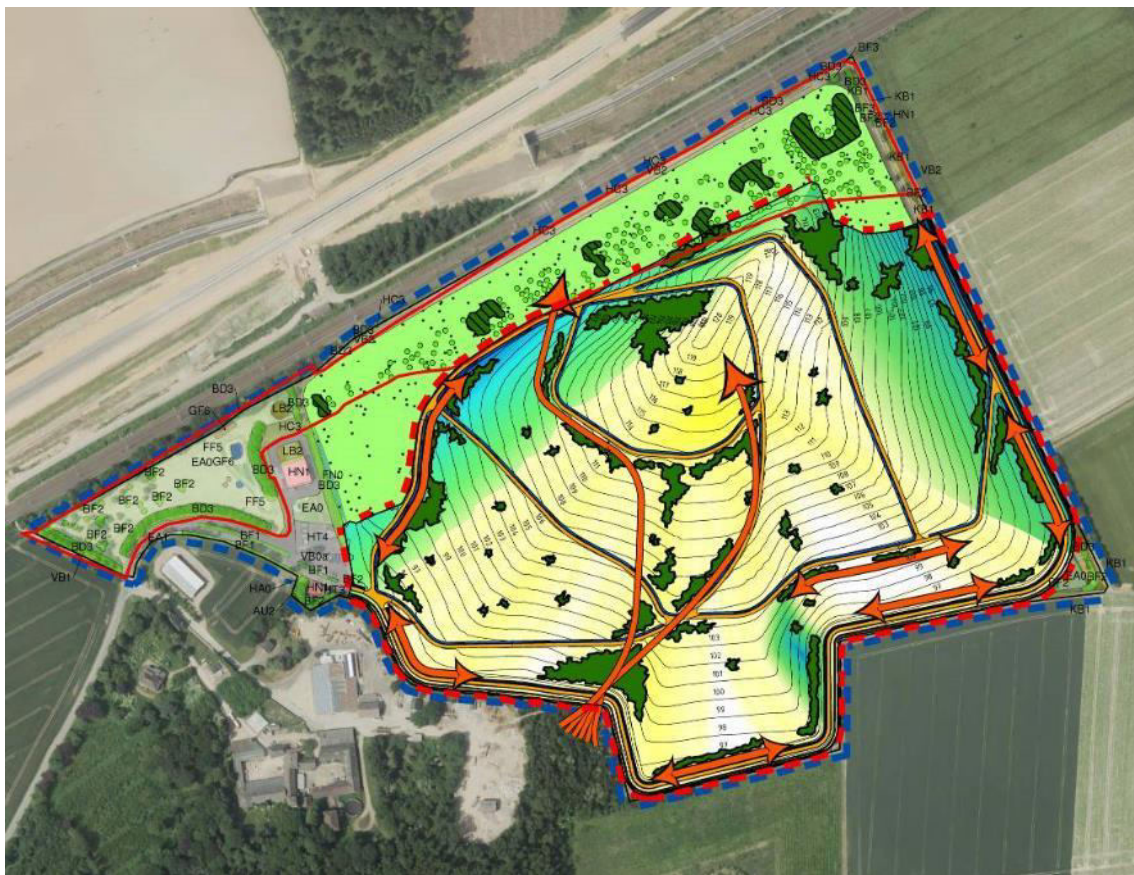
Rekultivierungsplanung mit Planfeststellungsbeschluss vom 29.06.2018.
